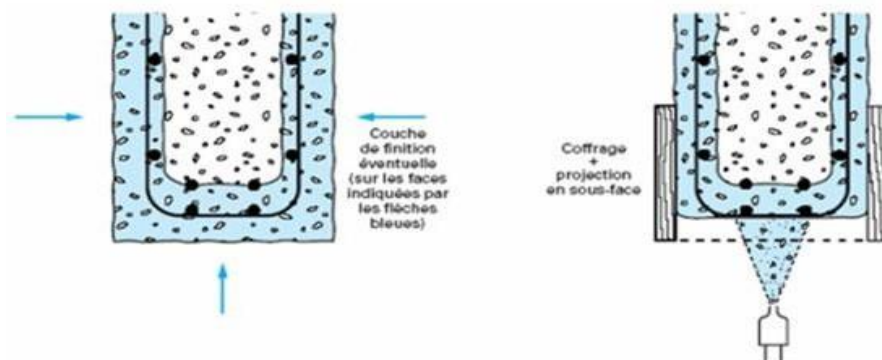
Réparation de poutre par béton projeté. [(Resse C, Venaut M). 1981]
